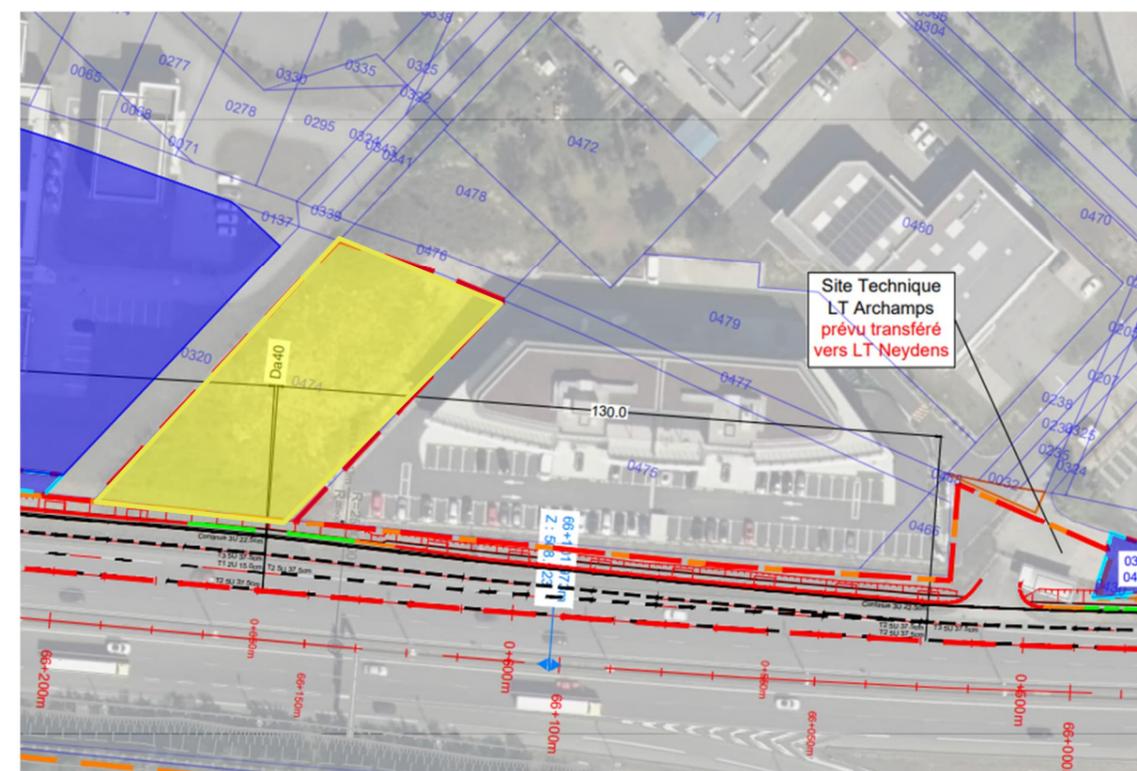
Zone d'installation de chantier projetée (en jaune)
